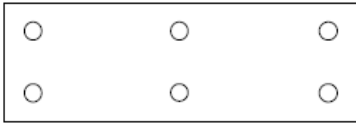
Plans de chevillage – panneaux de dimensions 1200 x 400 mm
